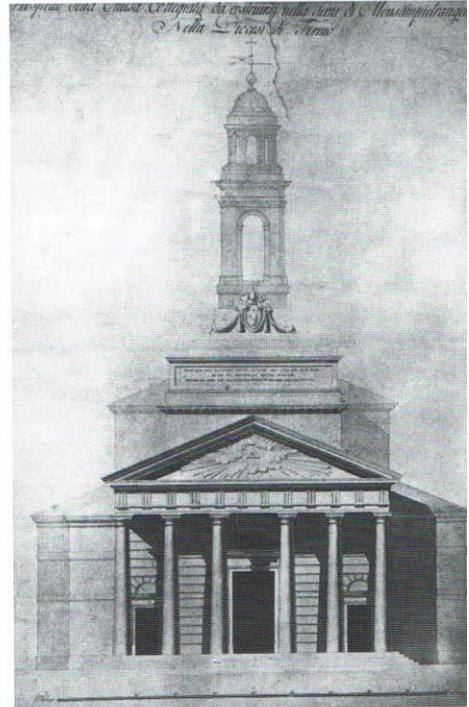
Prospetto della collegiata di Montespiertrangeli. Il Val' ha redatto il progetto nel 1796.
